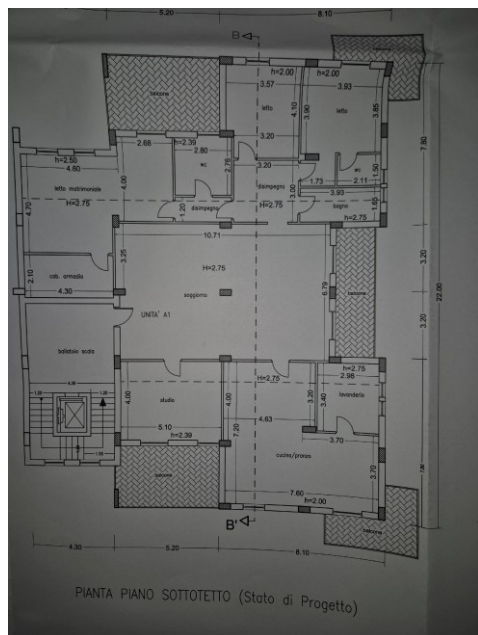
planimetria del quinto piano mansardato secondo il P.d.C. n.196/2011
